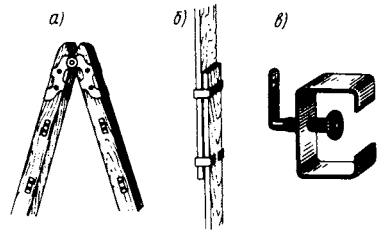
Лестница-стремянка а — металлический шарнир двойной лестницы; б — надставка; в — зажим для надставки
